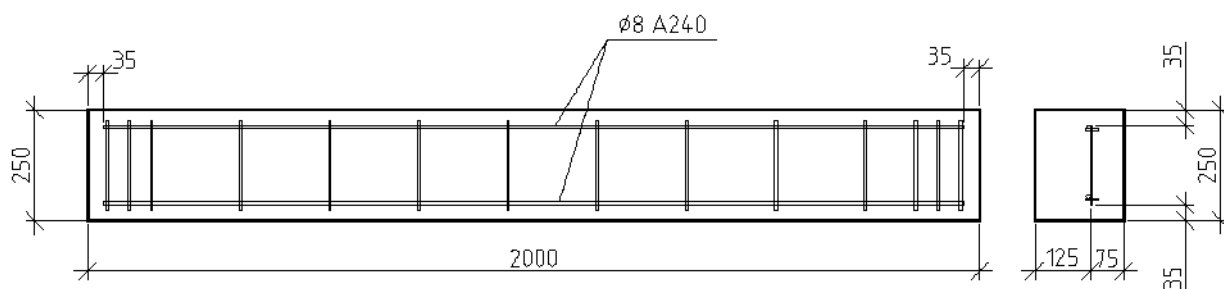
Схема армирования перемычки с плоским каркасом
